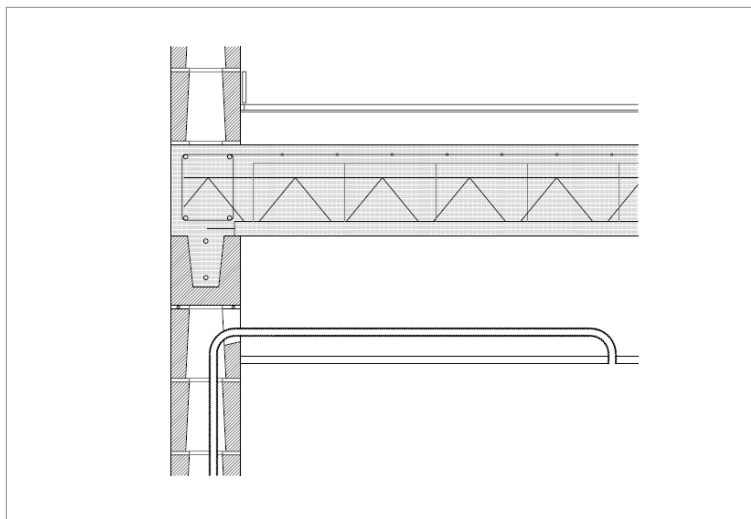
Salida de la instalación en coronación. Con existencia de falso techo.
